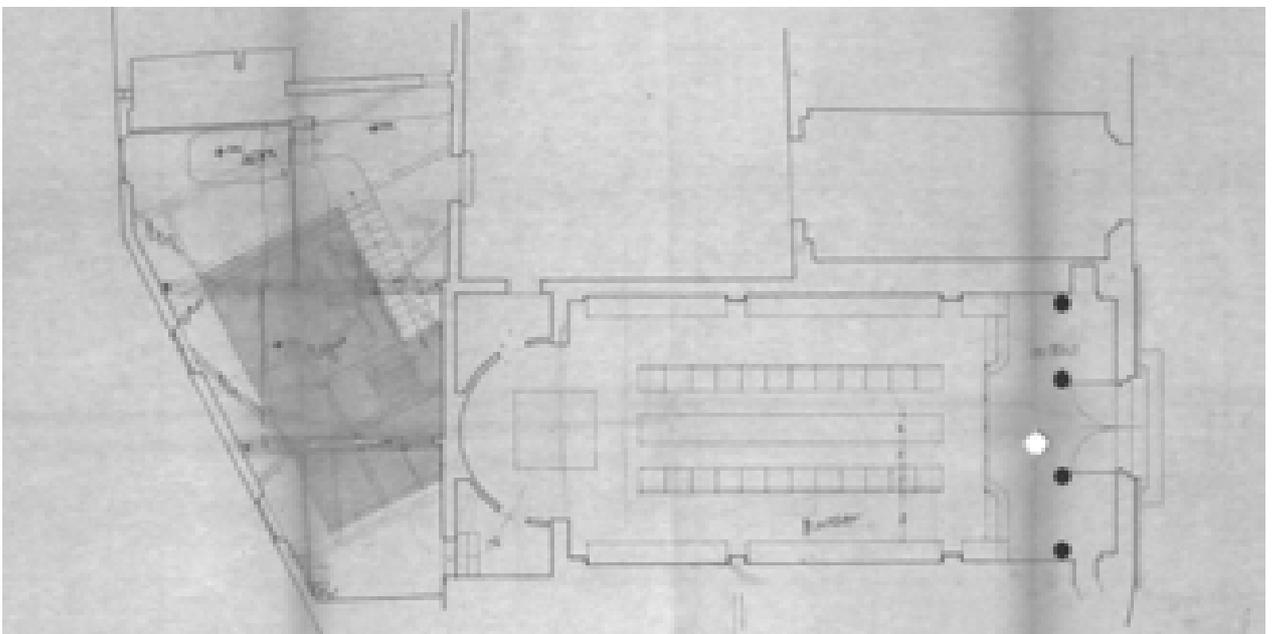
San Leonardo, pianta +0,00 – stato futuro - s.d. (AABS-94.013)
